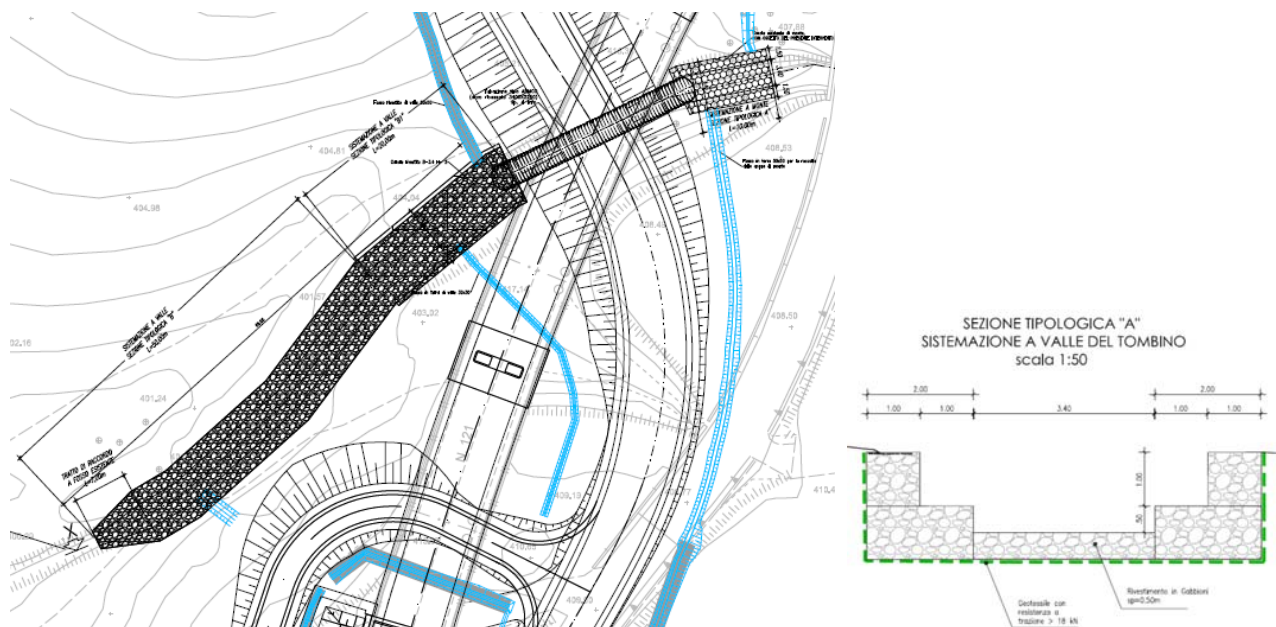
Stralcio planimetria e sezione tipo inalveazione di valle TS26
